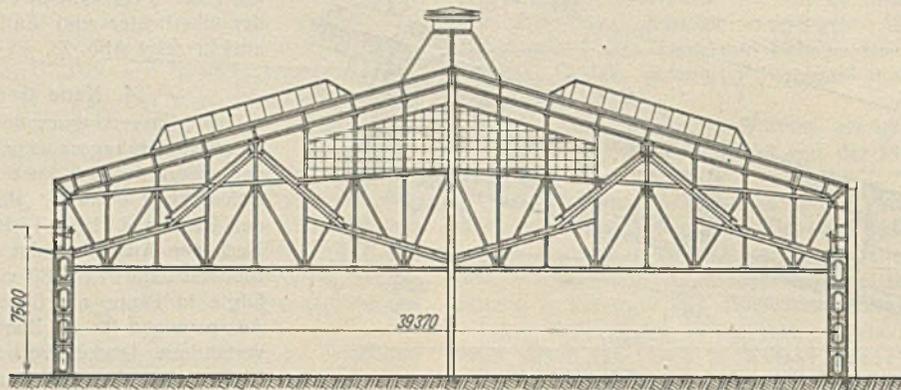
Stahlfachwerk-Giebelwand zum Anschluß gegen Hallen B u. C.
